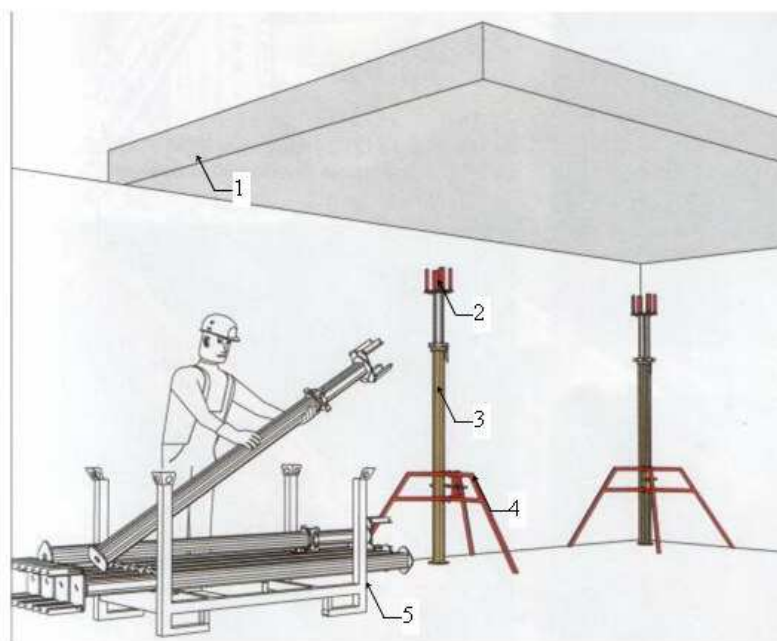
Демонтаж основных стоек: 1 – вновь возведенное перекрытие; 2 – унивилка; 3 – стойка; 4 – тренога; 5 – контейнер для складирования элементов опалубки
